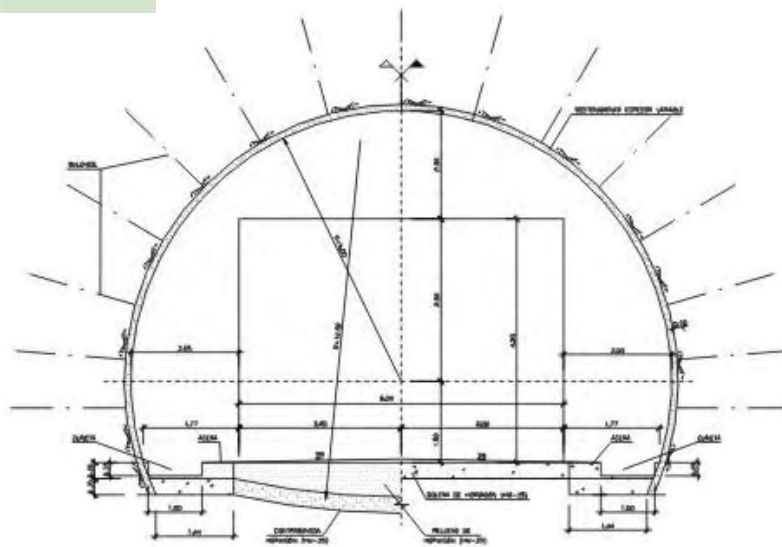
Sección tipo de la galería de Folledo/Standard cross-section of the Folledo access adit..
